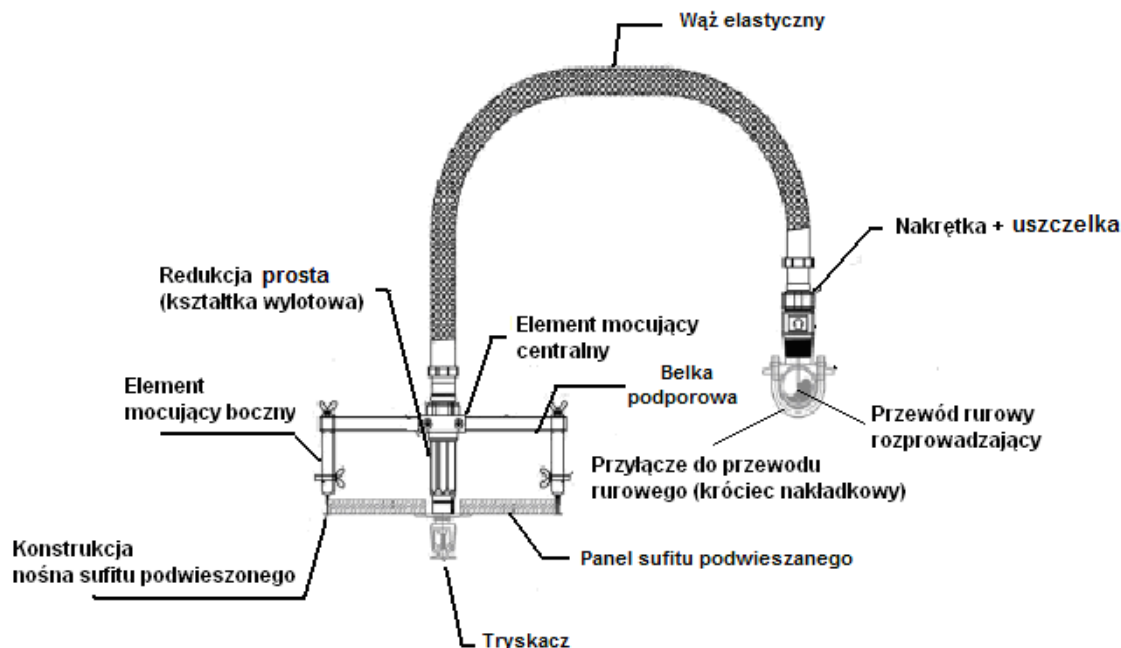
Konstrukcja łączników elastycznych węzowych PROFLEX wraz z elementami mocowania (widok po zainstalowaniu na konstrukcji nośnej sufitu podwieszonego)
